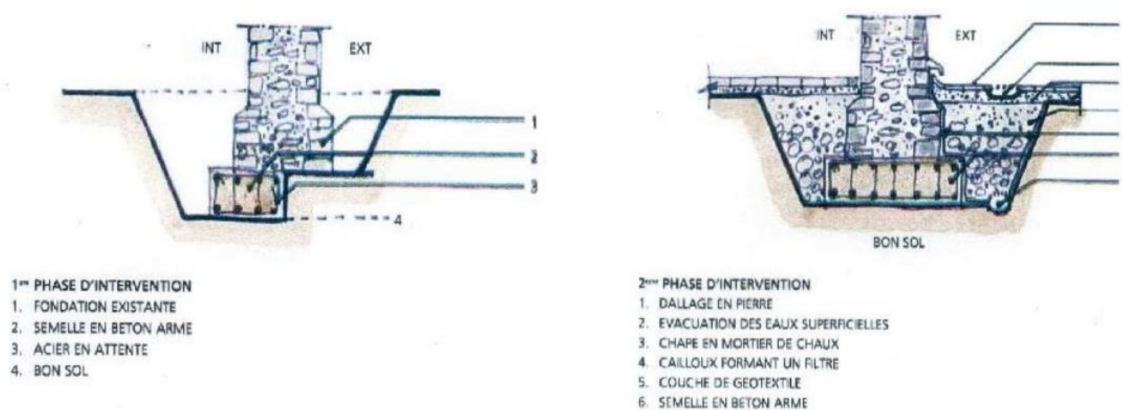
Consolidation d'une fondation par semelle en béton armé.
